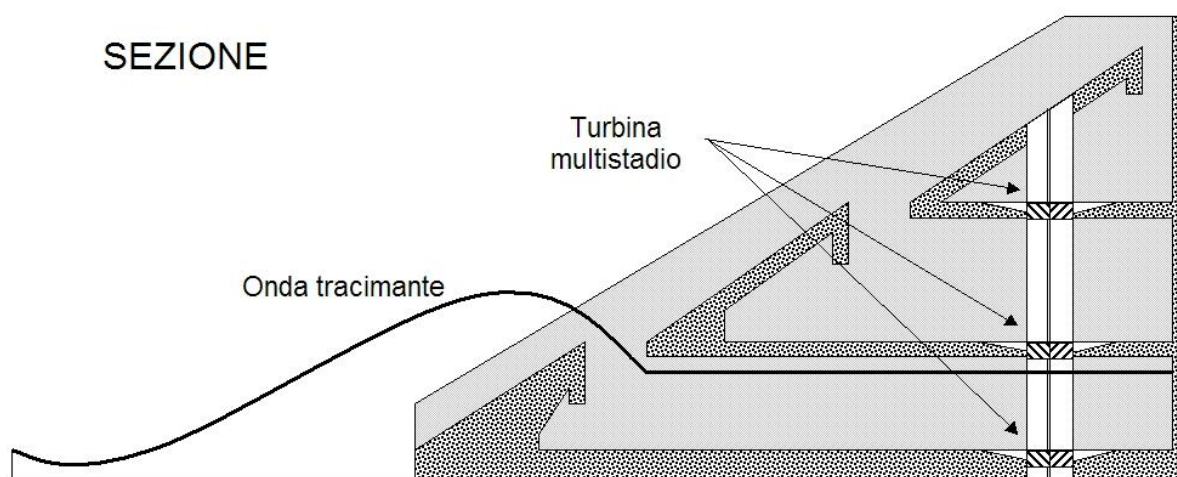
Schema di impianto a tracimazione, installazione fissa.
